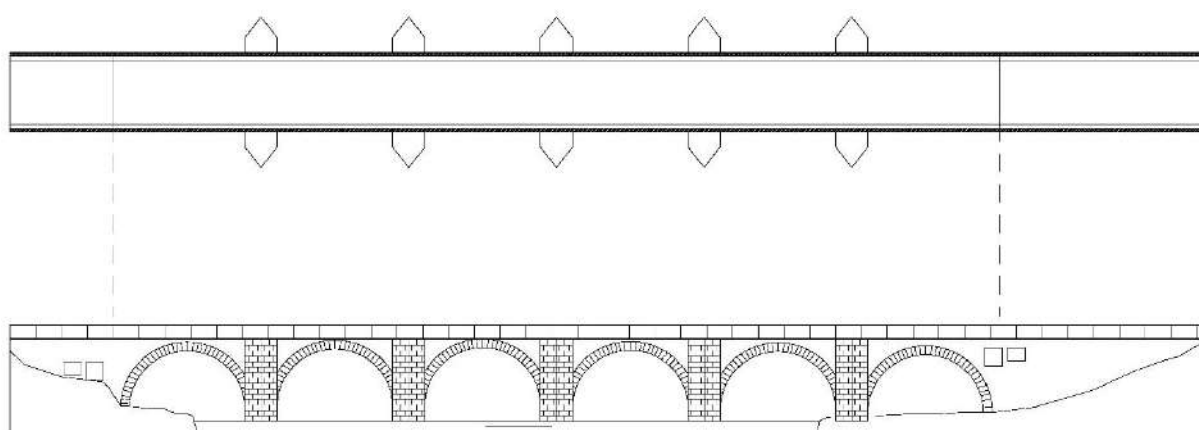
Planta e Alçado Sul da Ponte da Pedra sobre o Rio Tuela
